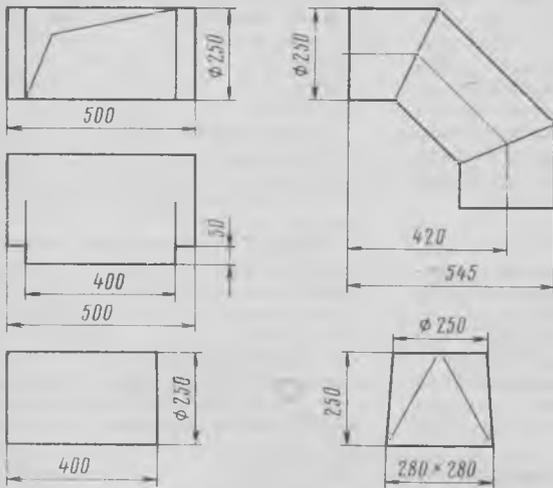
Воздуховоды, переходы, отводы и насадки системы вентиляции
